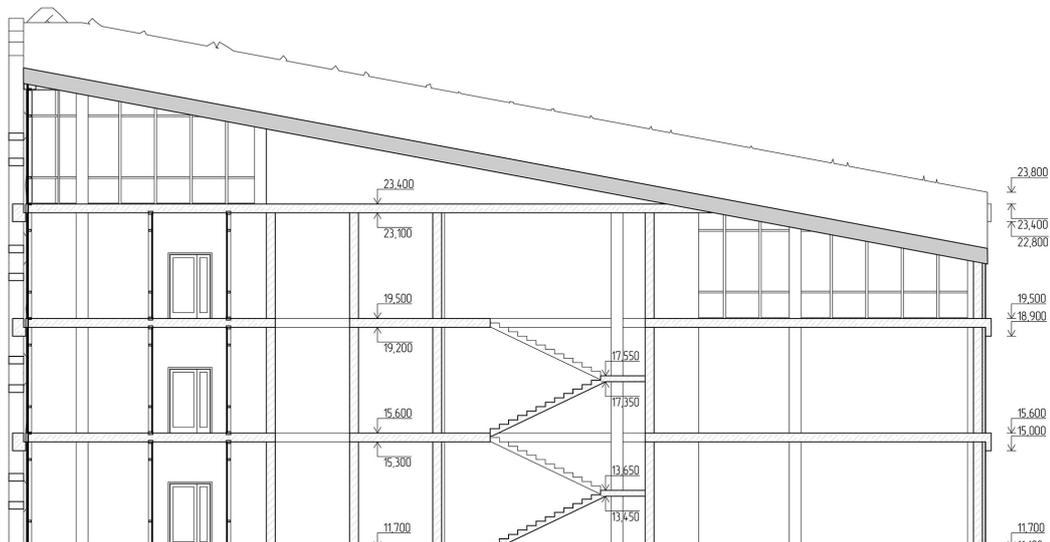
Фрагмент креслення похилого даху офісних будівель
